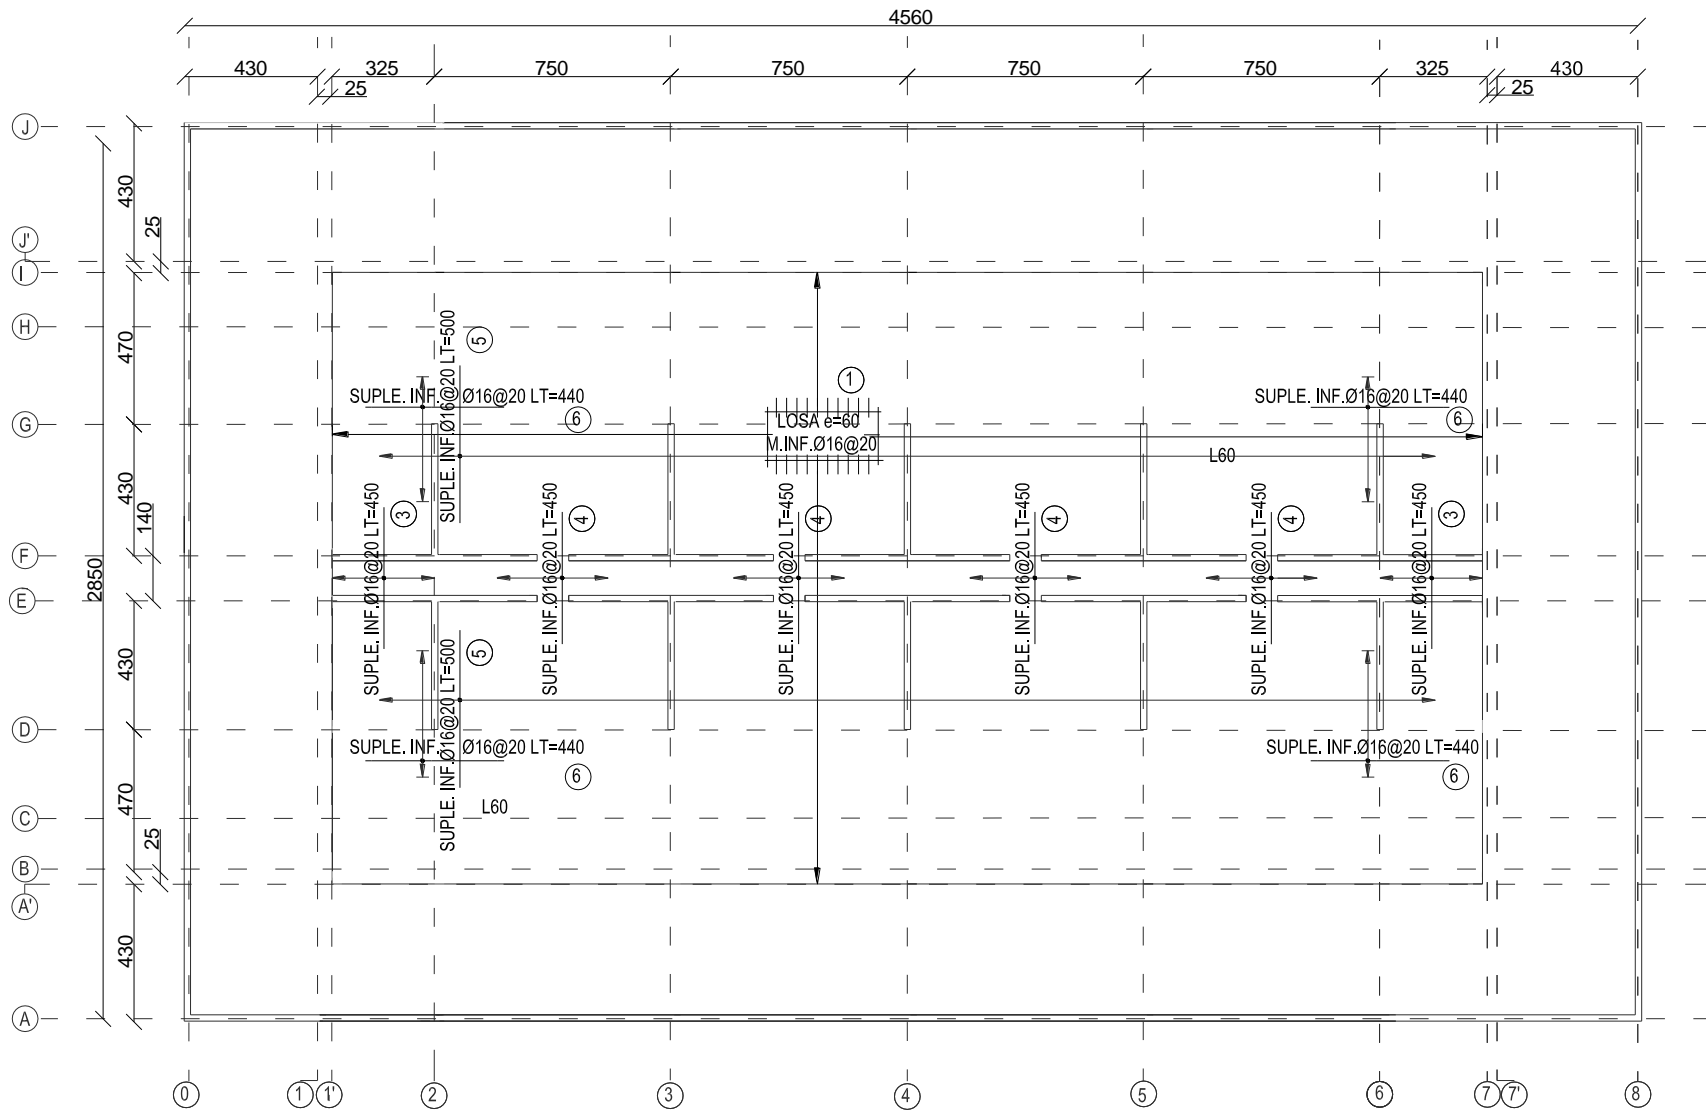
Planta losa de estabilización armadura inferior de edificio aislado.
